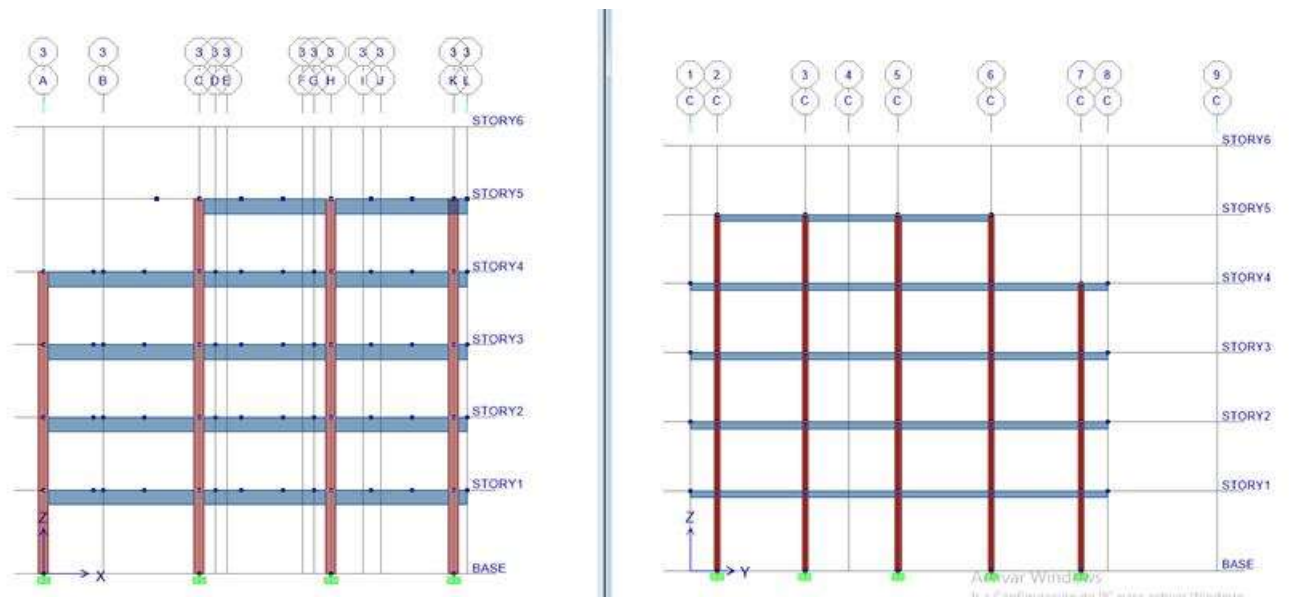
Esqueleto Estructural para el proyecto ETABS – Vistas Laterales
